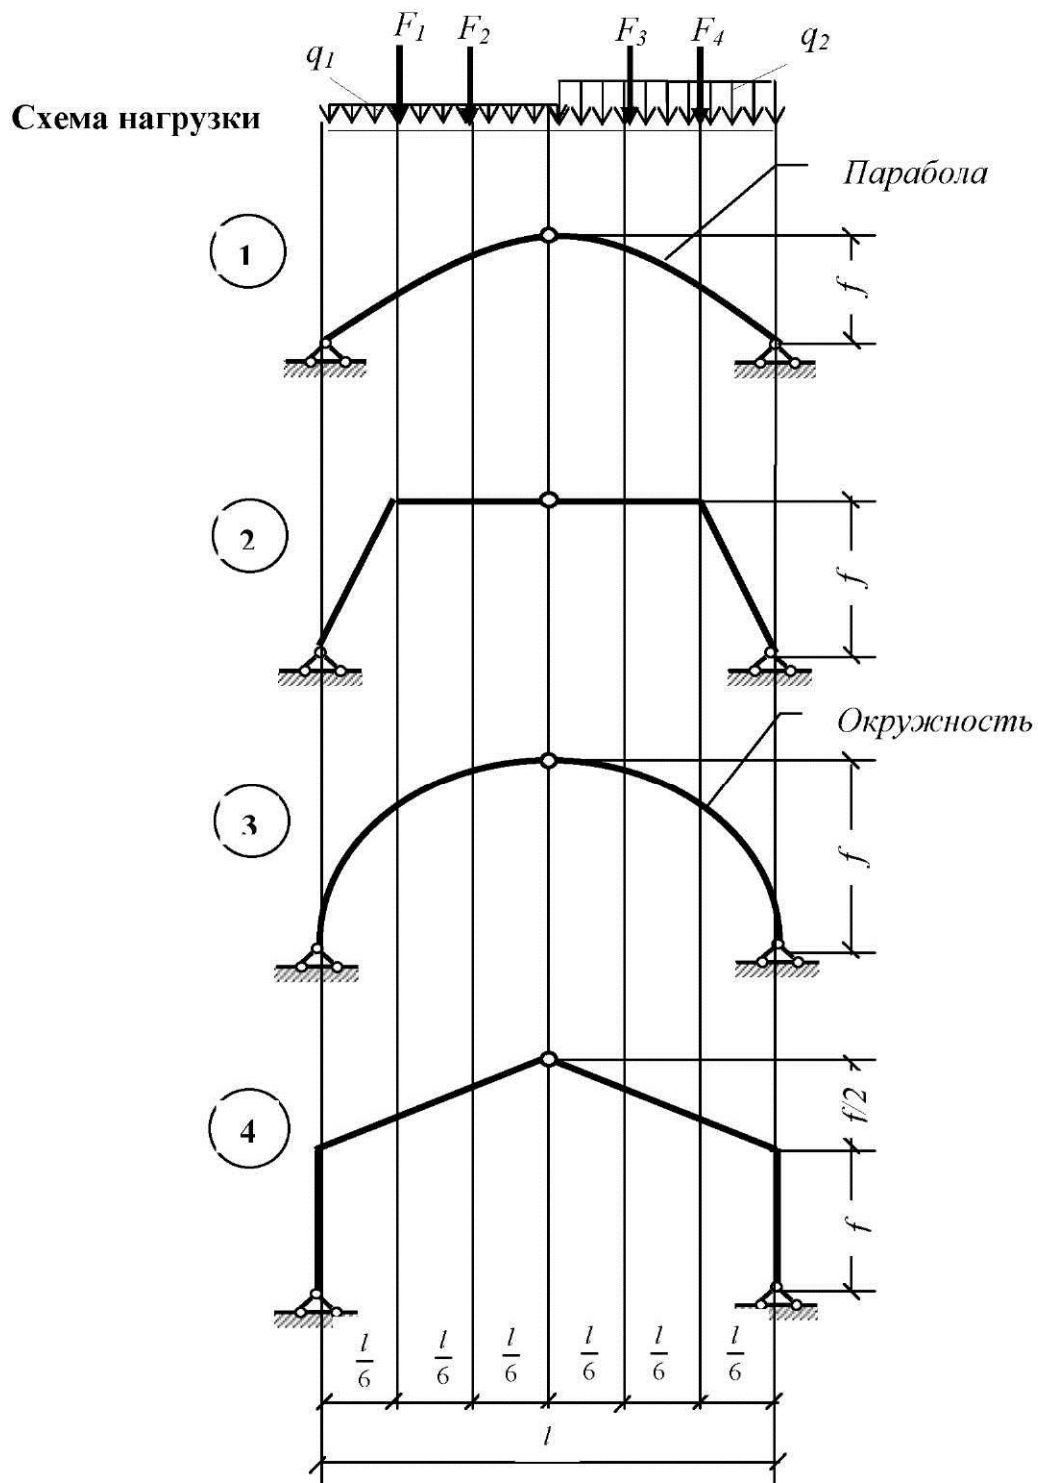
Расчетные схемы распорных систем и схема нагрузок для задачи № 2
